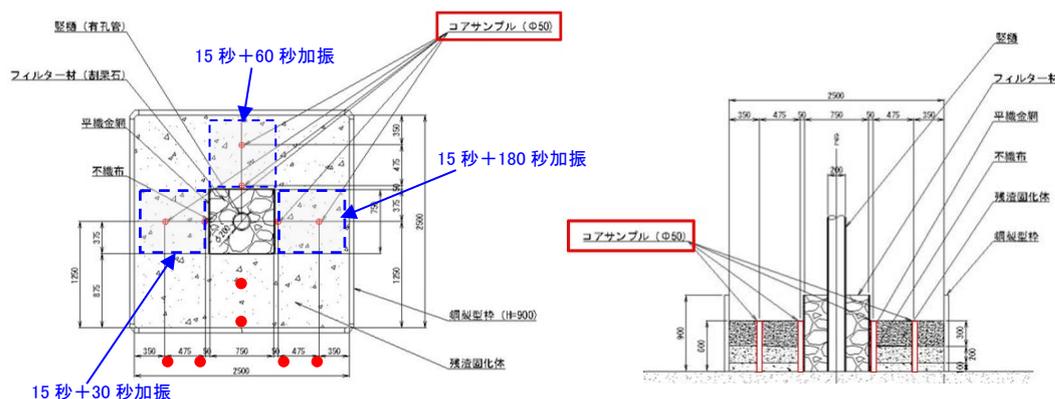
フィルター材との鉛直接合部近辺でのコア採取位置(左:平面図、右:縦断面図)
